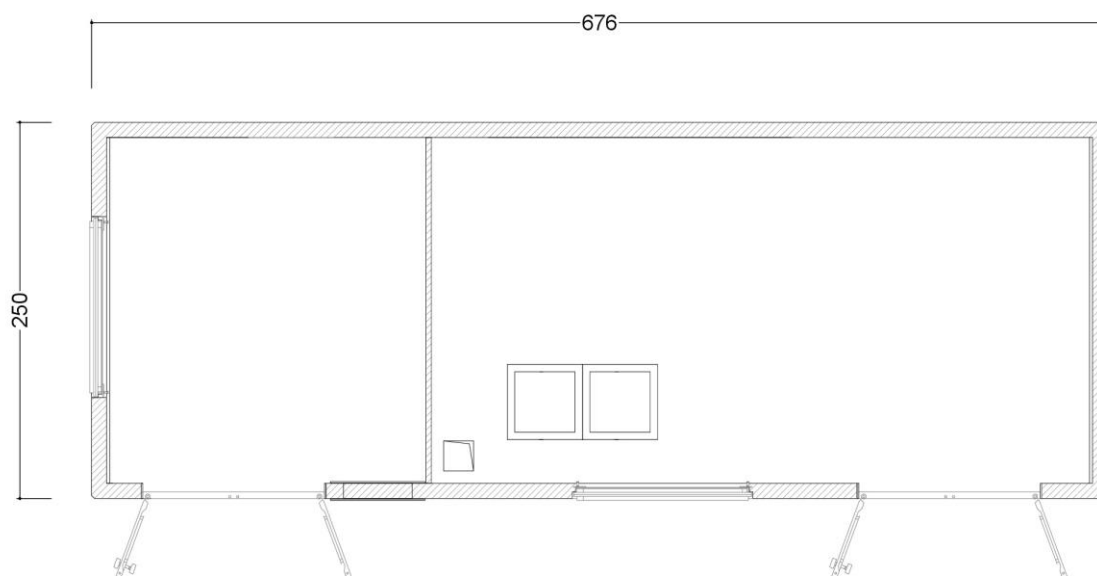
locale utente a servizio degli impianti di utenza per la connessione
